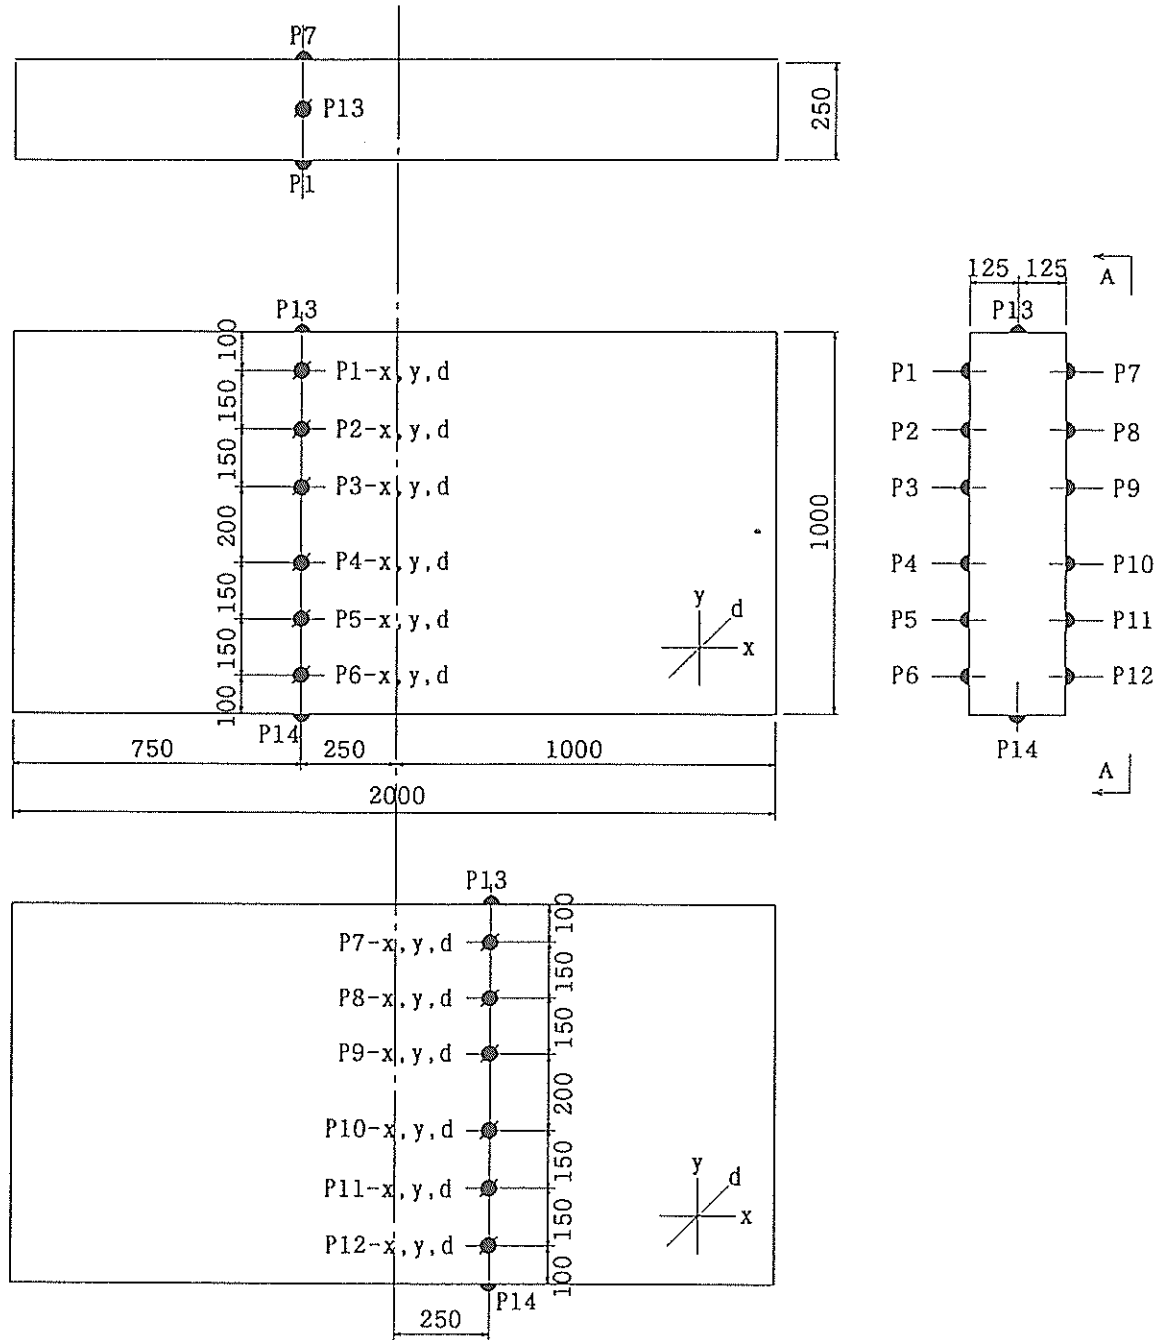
コンクリートのひずみ計測位置 (RC各供試体共通)
